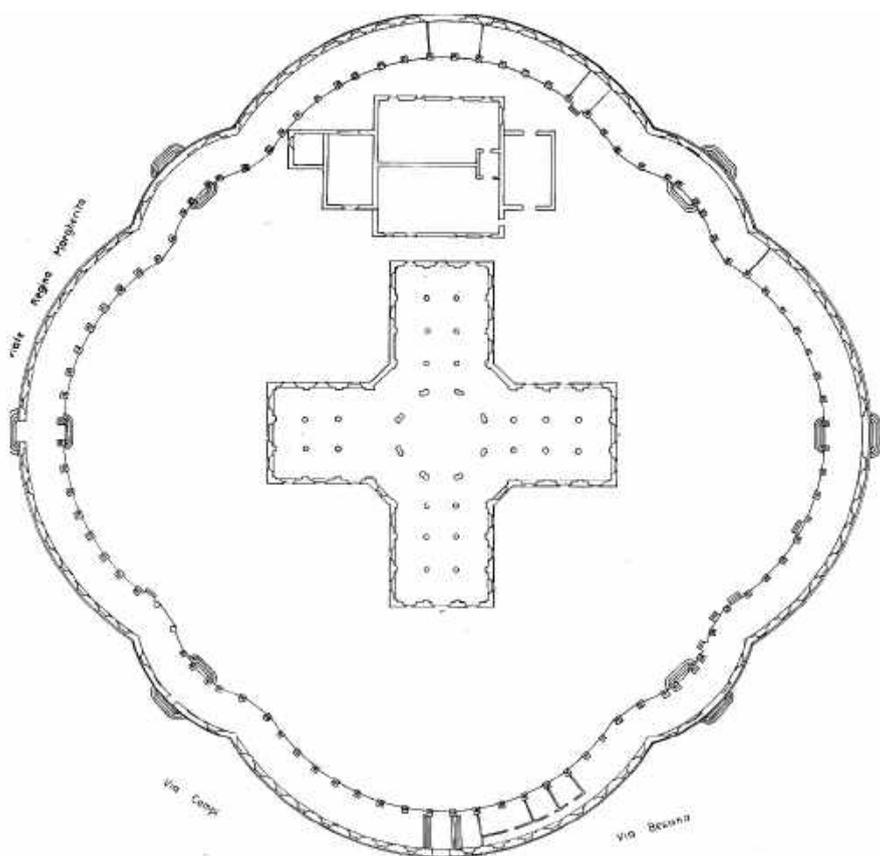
Pianta piano terra, prima dei bombardamenti
